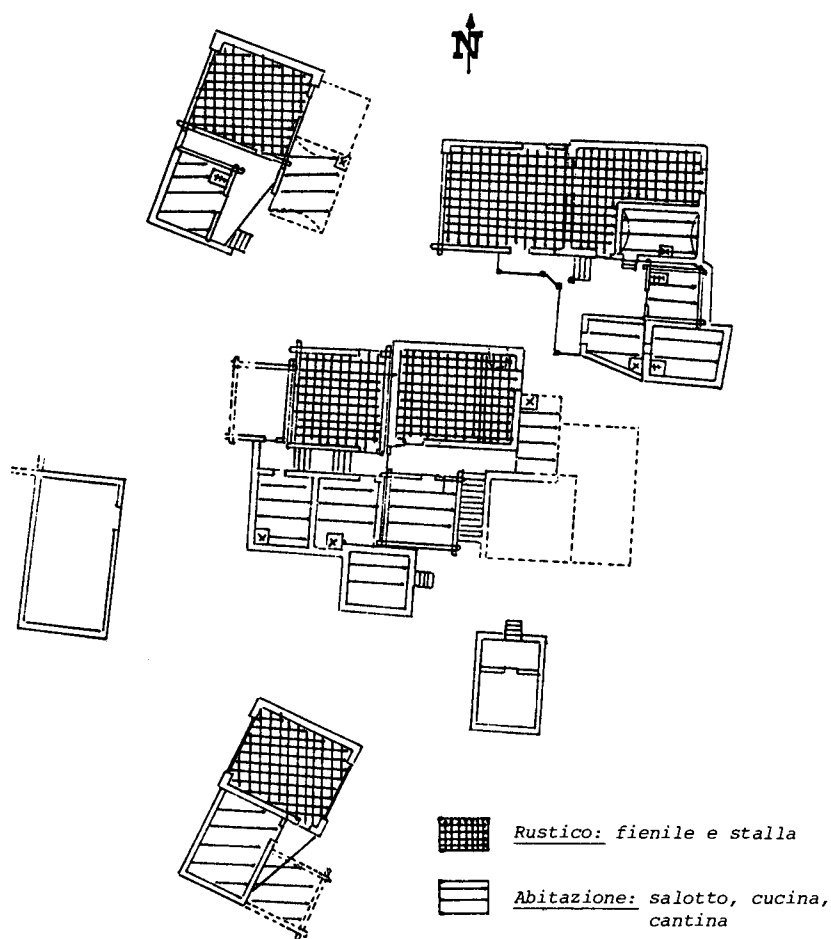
planimetria degli edifici: il rustico è costruito a nord, l'abitazione a sud
